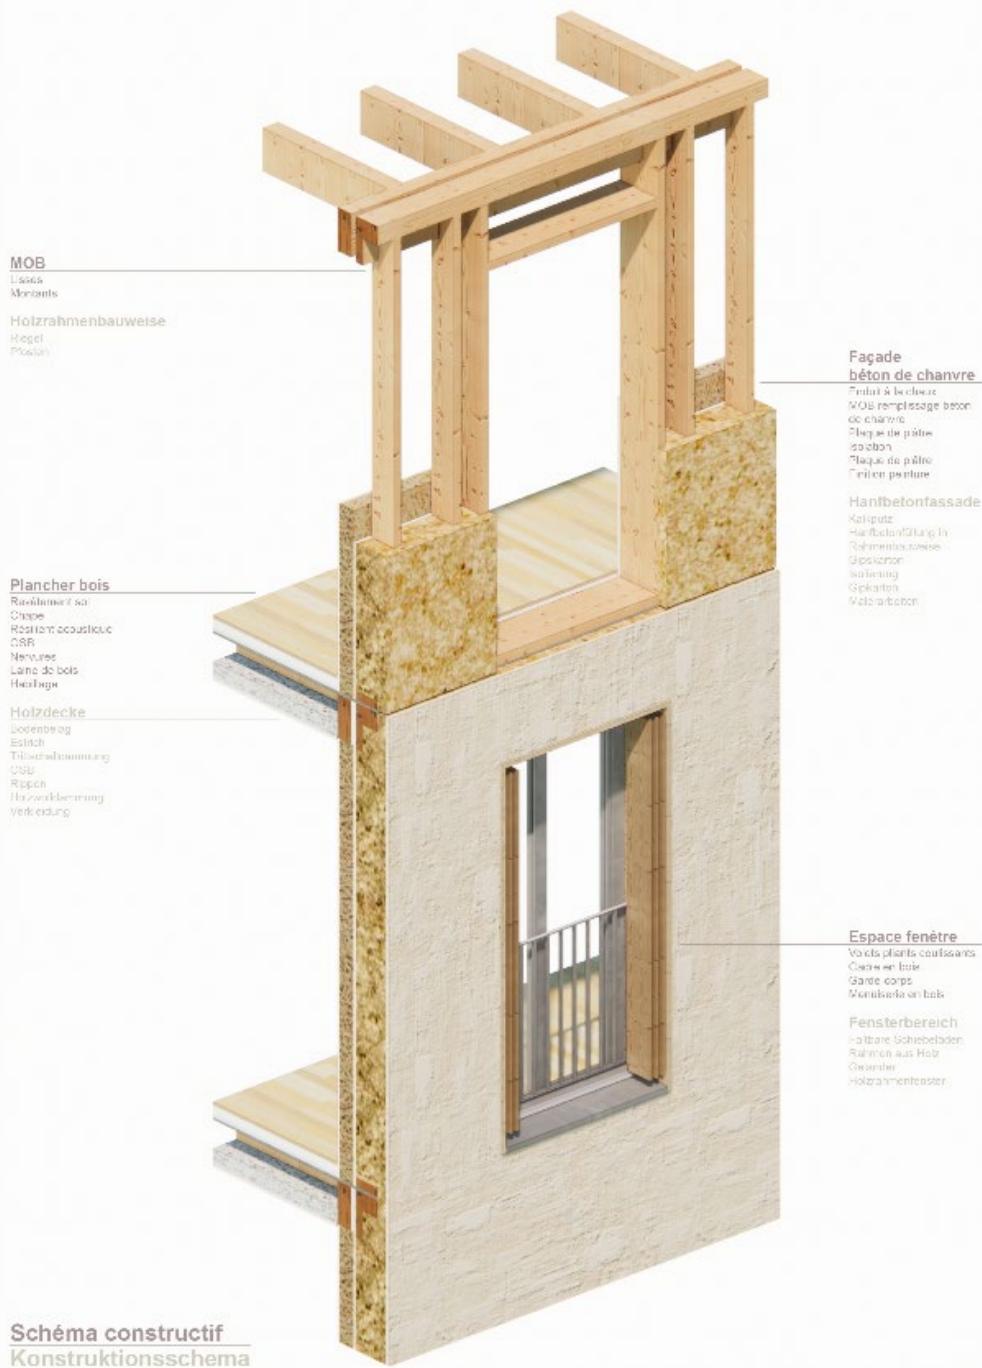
Konstruktionsschema zum Fassadenprinzip | schultearchitekten gmbh
